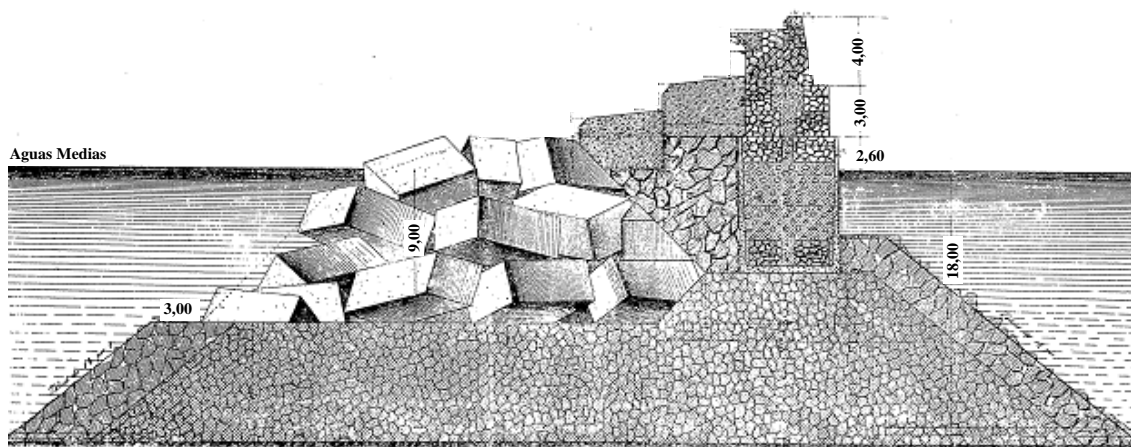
Perfil del dique de Levante utilizando cajones de hormigón armado (Aixelà, 1915).
